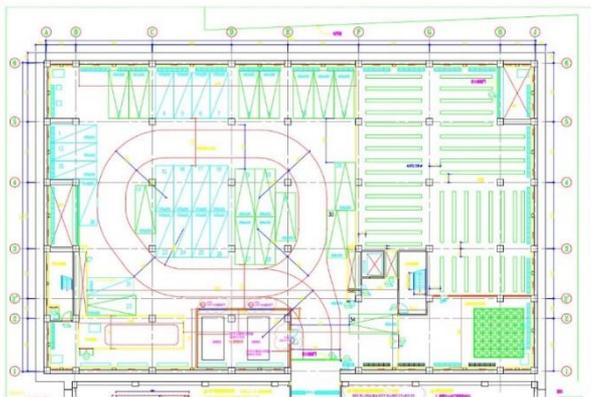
三至九層、十一至十二層平面圖 (S: 1/200)
